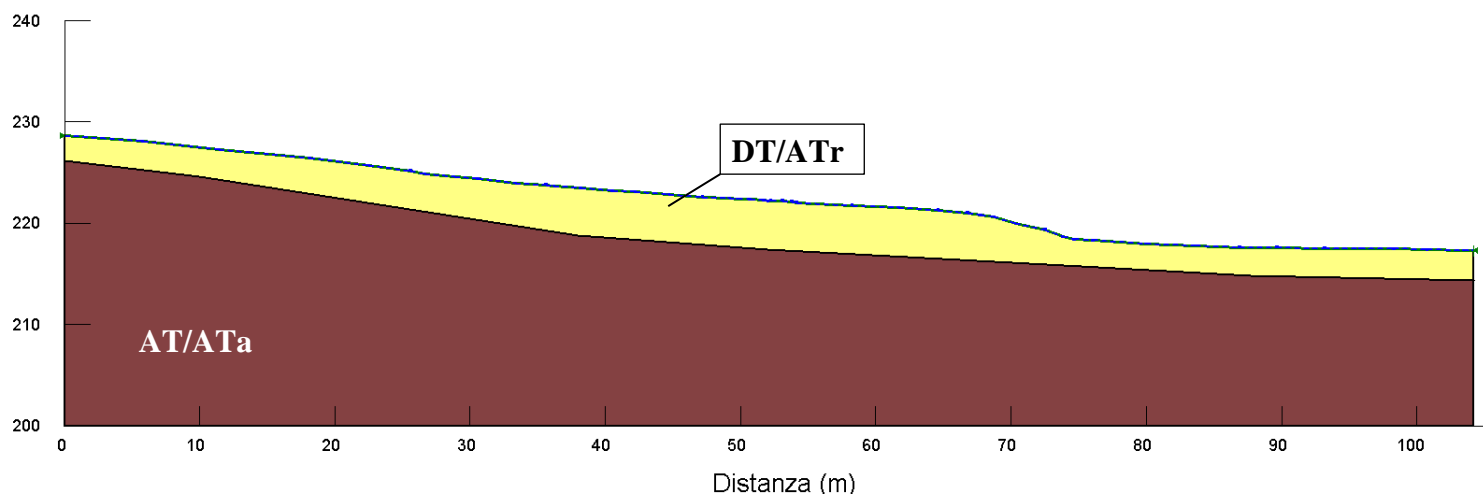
Rapporti opere – terreni lungo la sezione T3
